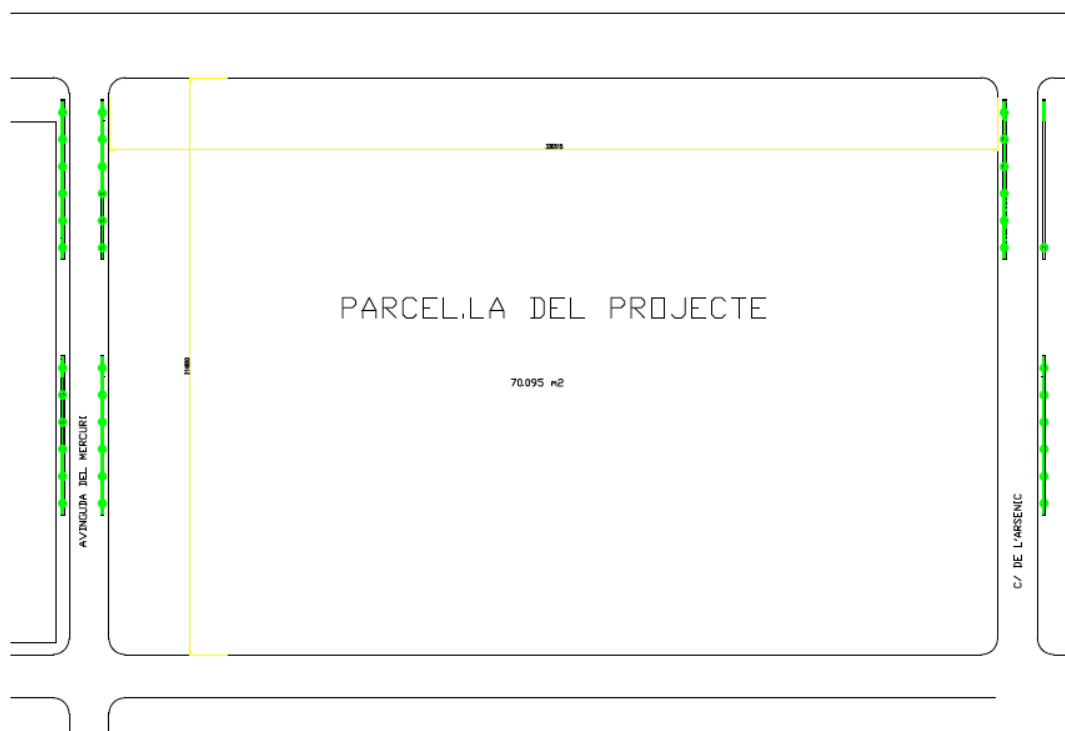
Parcela disponible para la construcción de la planta de Acetaldehído.
